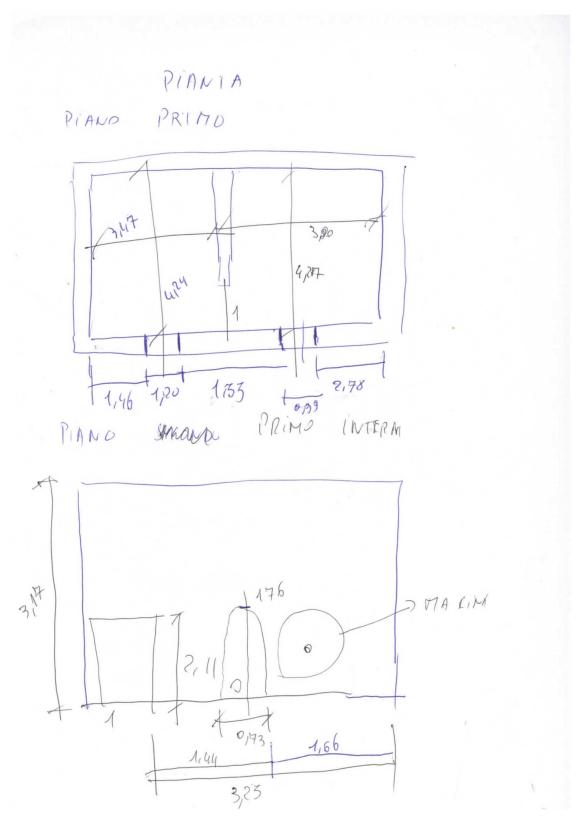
Piano terra e prospetto parete interna, su piano terra
